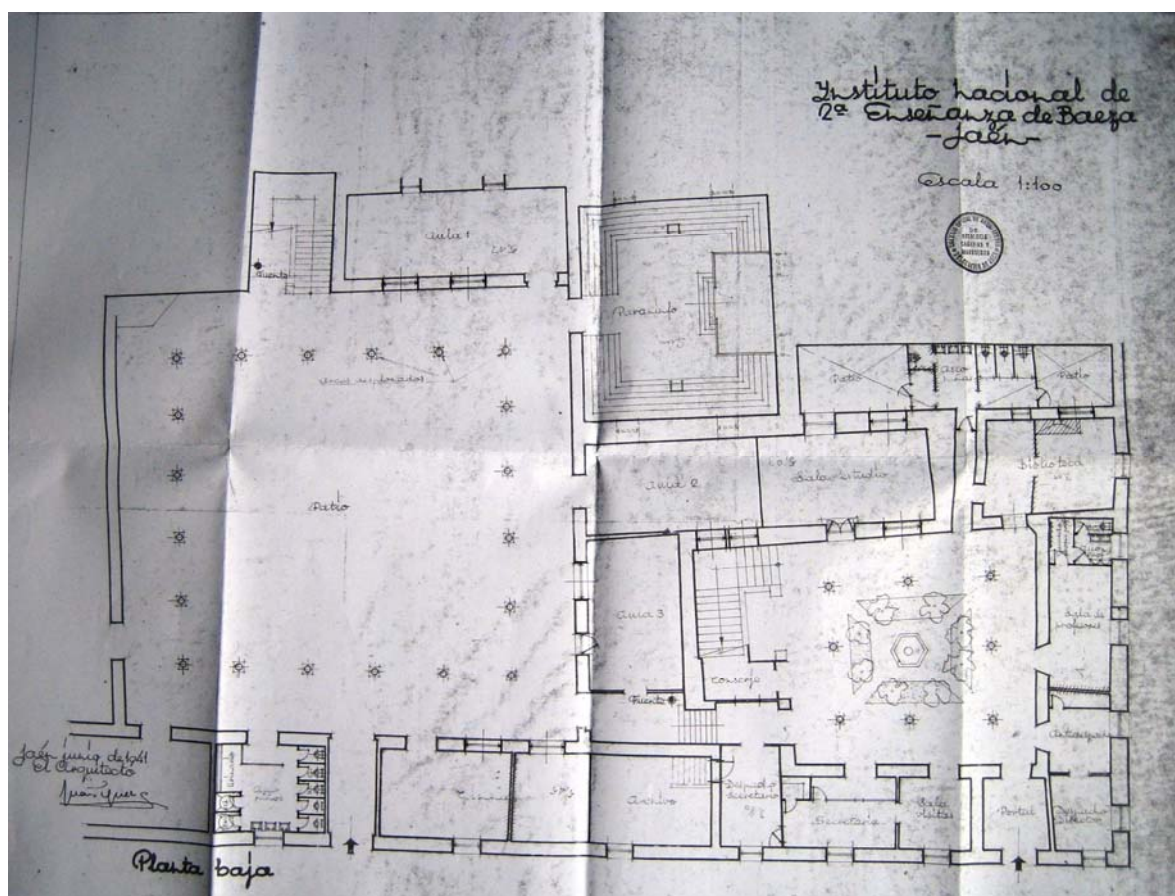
Planta baja. Proyecto de obras de reparación del Instituto Nacional de Enseñanza Media. AGA, IDD (5)14.2, caja 31/5560.
